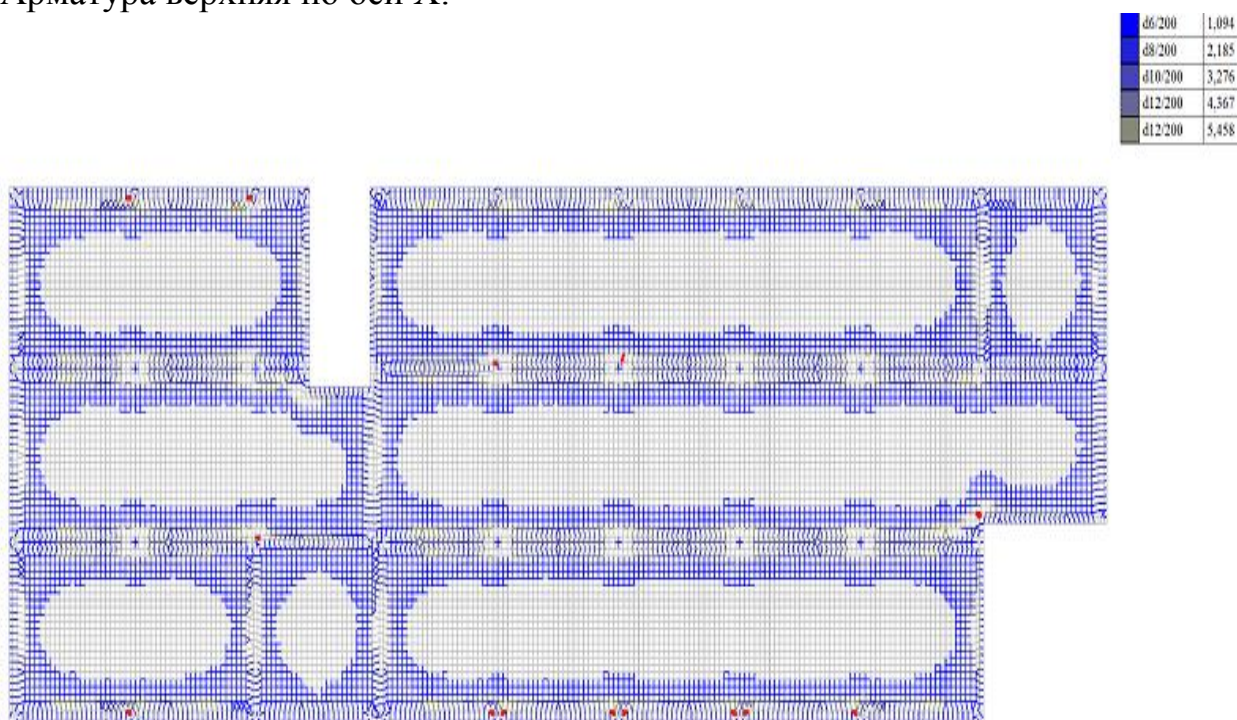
Схема верхнего армирования плиты по оси х
